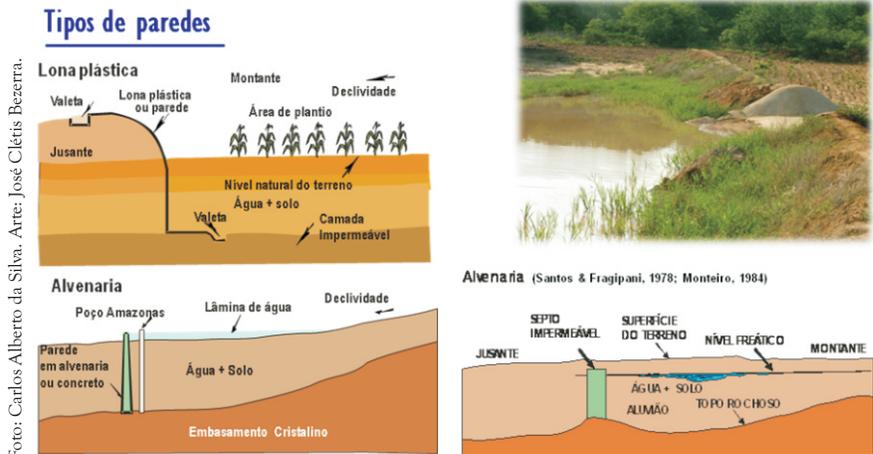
Tipos de paredes de barragem subterrânea construída com lona de polietileno ou alvenaria.
